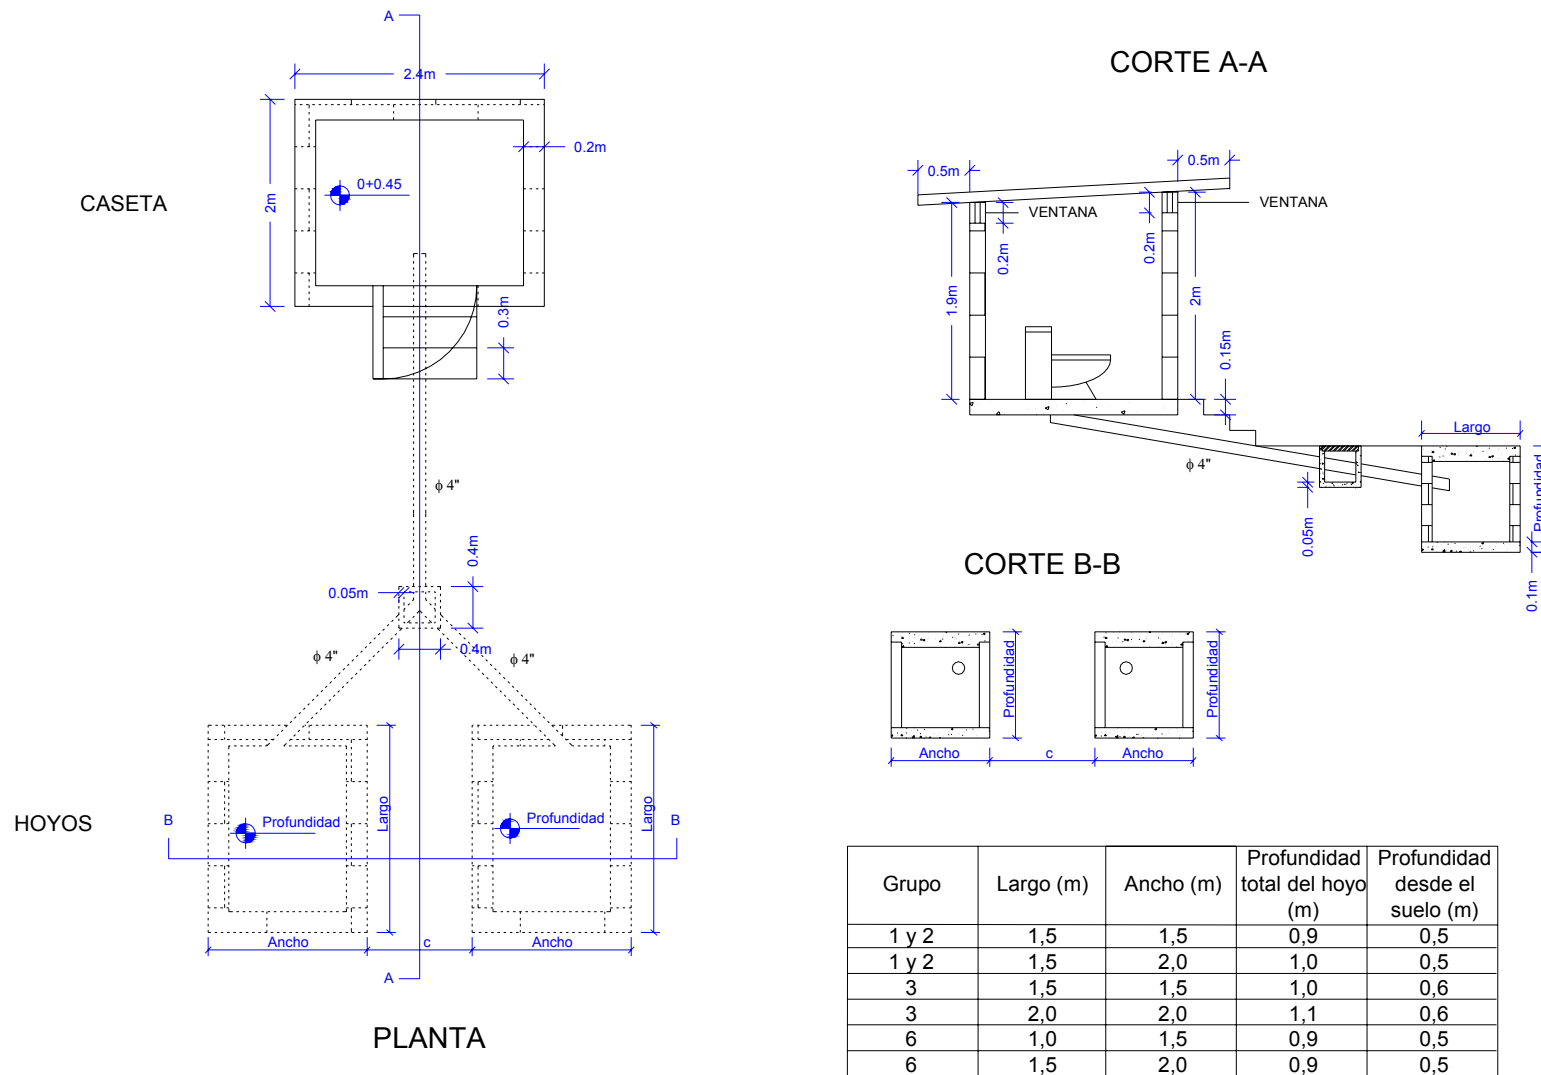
Sistema 1 - Letrina de hoyo doble elevado con cierre hidráulico
